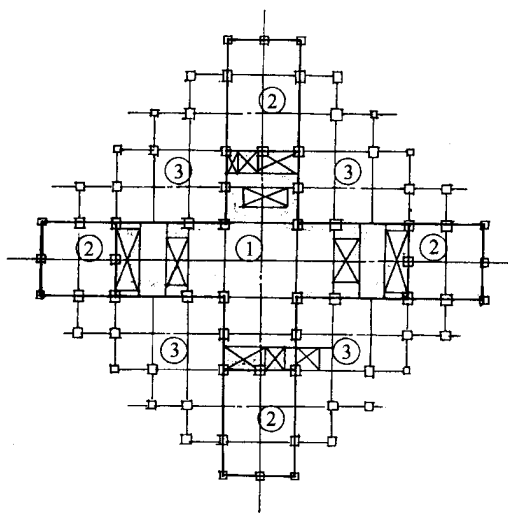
钢结构综合安装焊接顺序图
